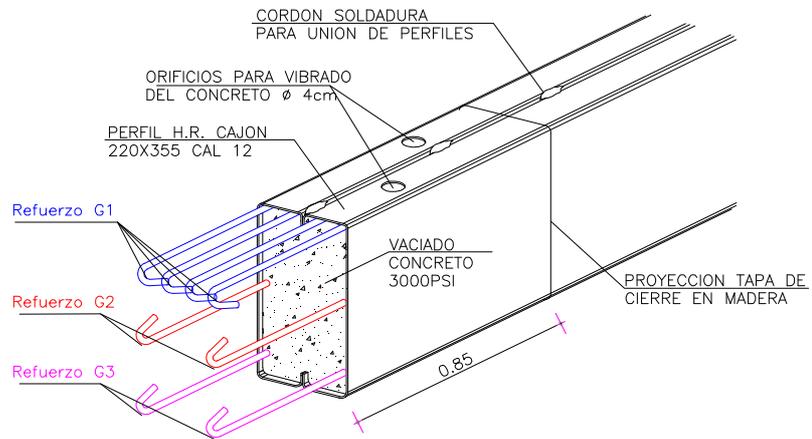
Armadura de anclajes de refuerzo por cortante
